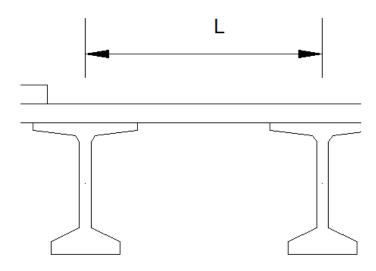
LONGITUD DE EJE A EJE DE VIGA (L)
